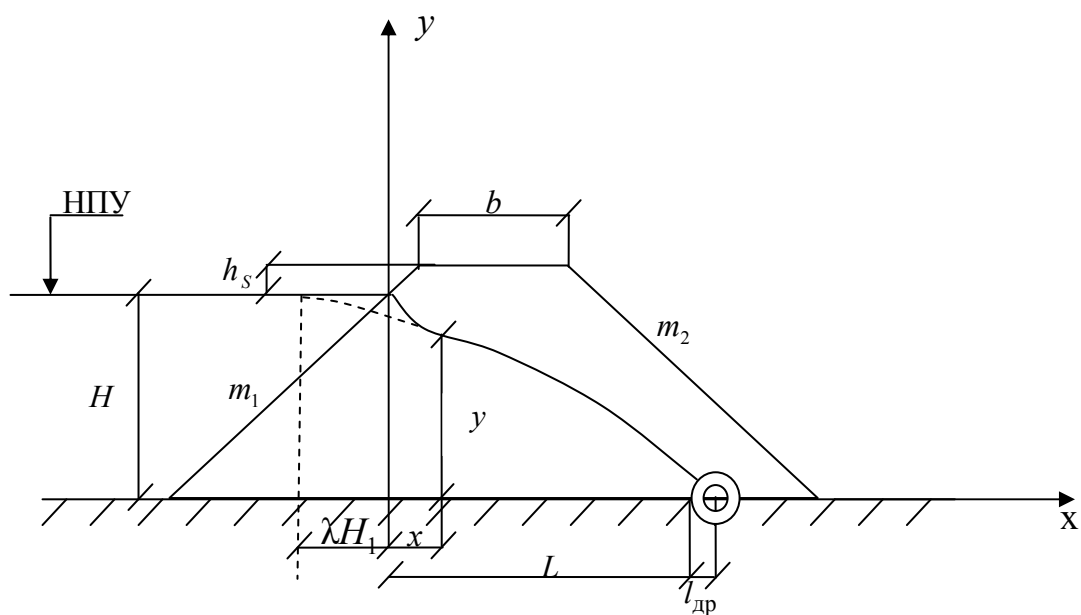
Схема к расчету через грунтовую плотину с трубчатым дренажом
